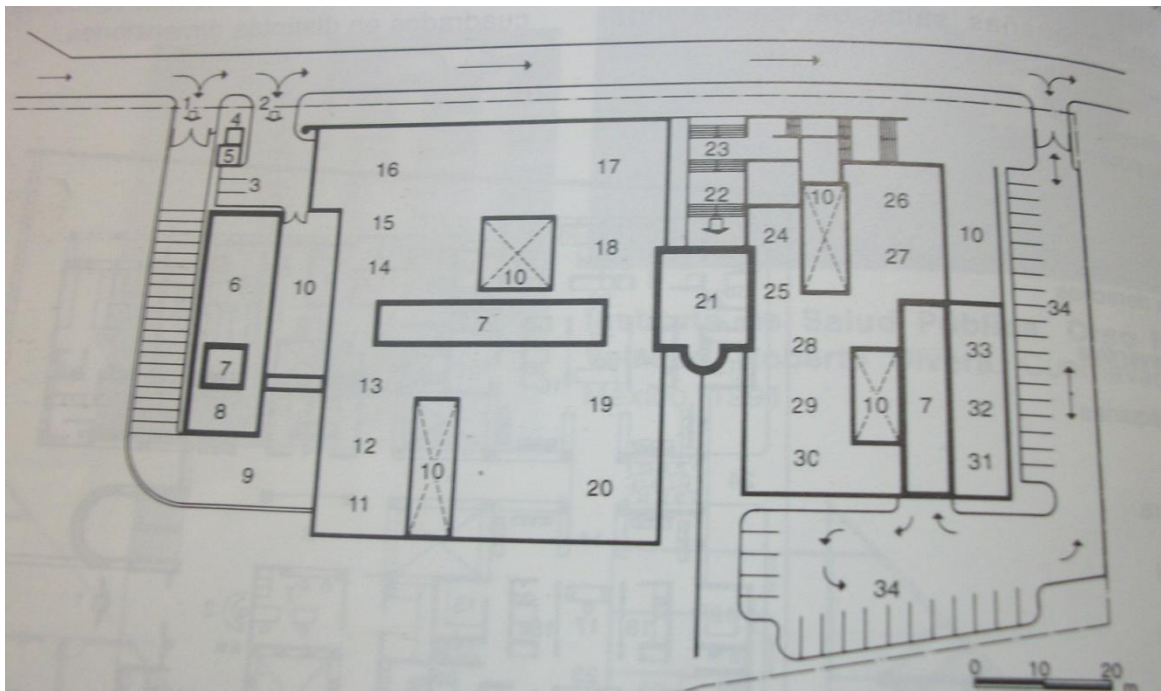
Planta de Conjunto S/E. Fuente: Plazzola tomo IV.
